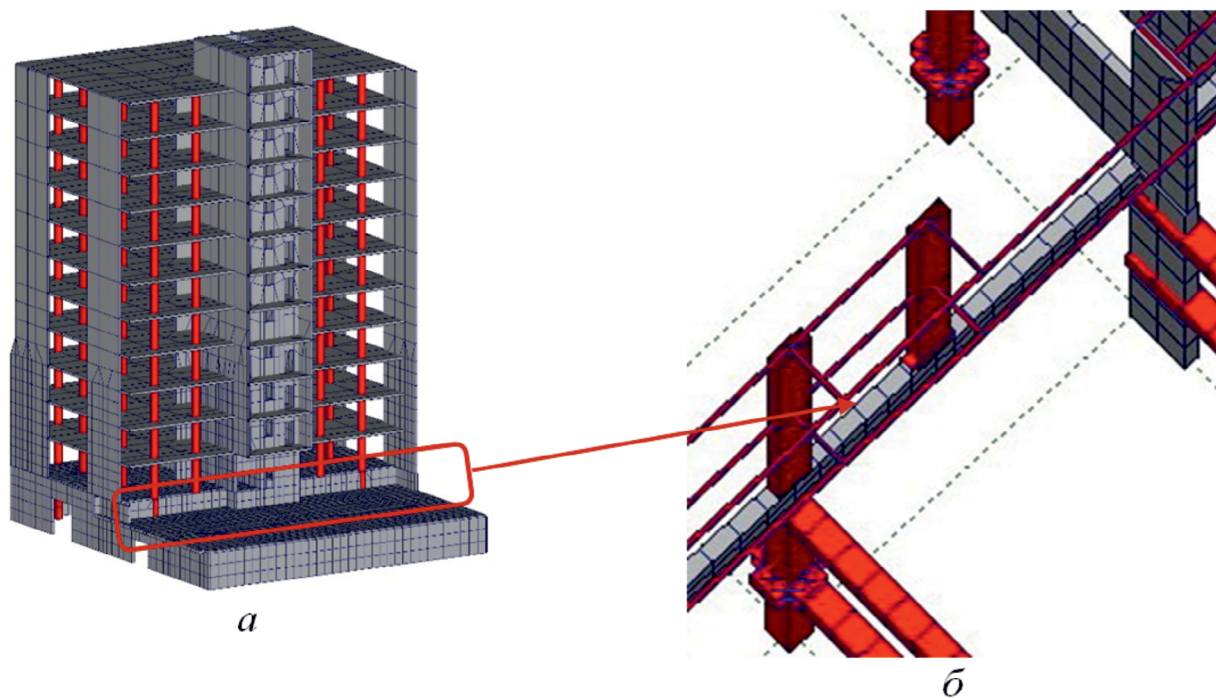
Принцип переопирания вертикальных несущих конструкций:
